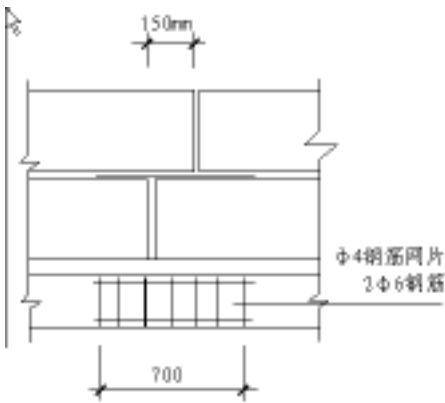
蒸压加气混凝土砌块砌
